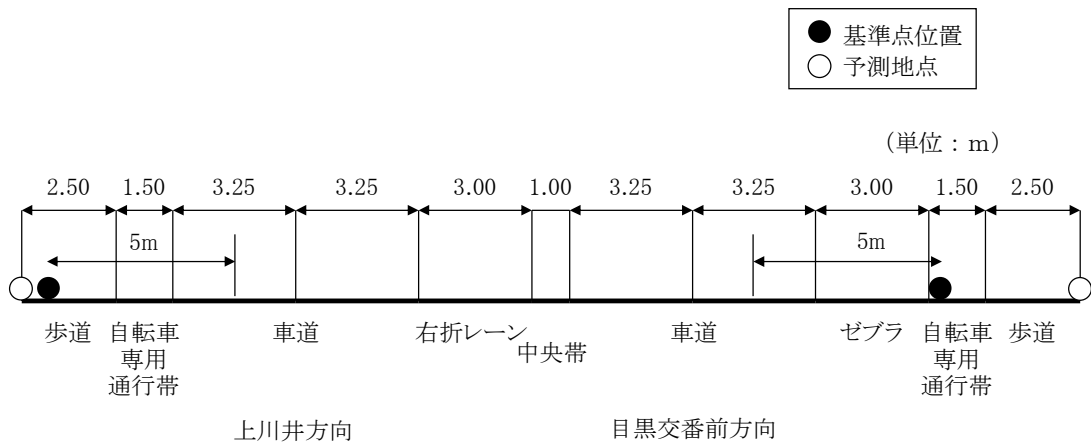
(3) 道路断面及び基準点の位置 (No. 3)
